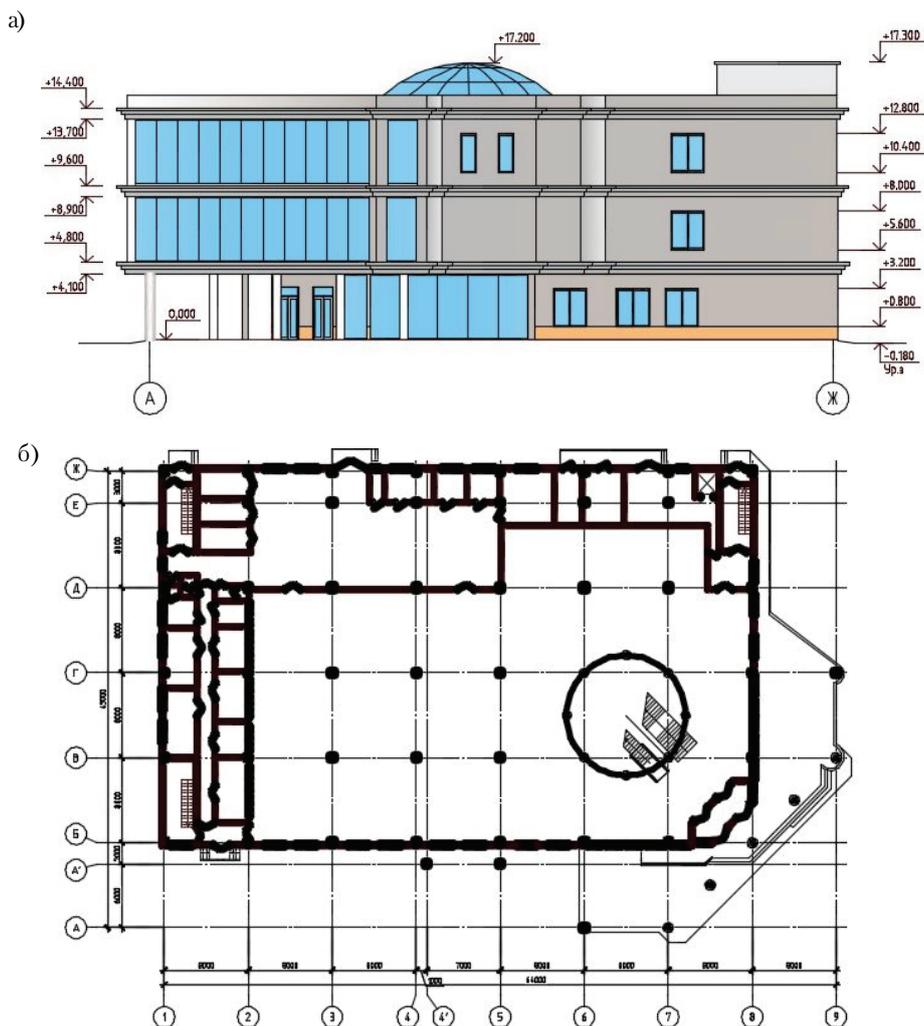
Объёмно-планировочное решение проектируемого здания: а) фасад; б) план.
